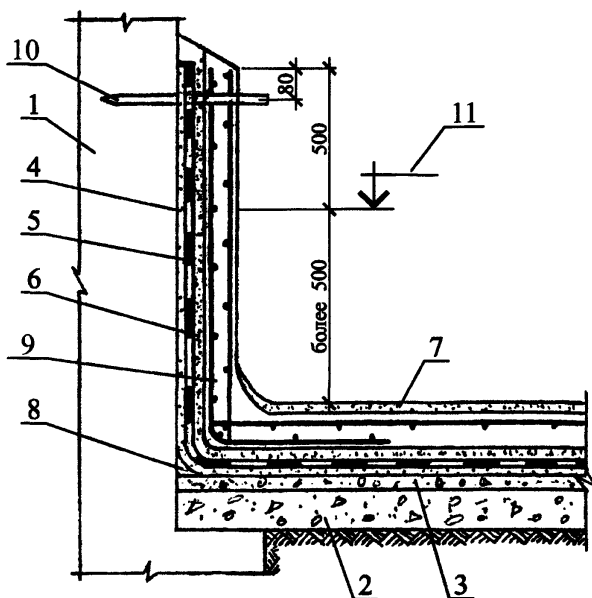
Гидроизоляция реконструируемых подвалов по грунту, при уровне грунтовых вод более 50 см (вариант армирования сварными сетками)
